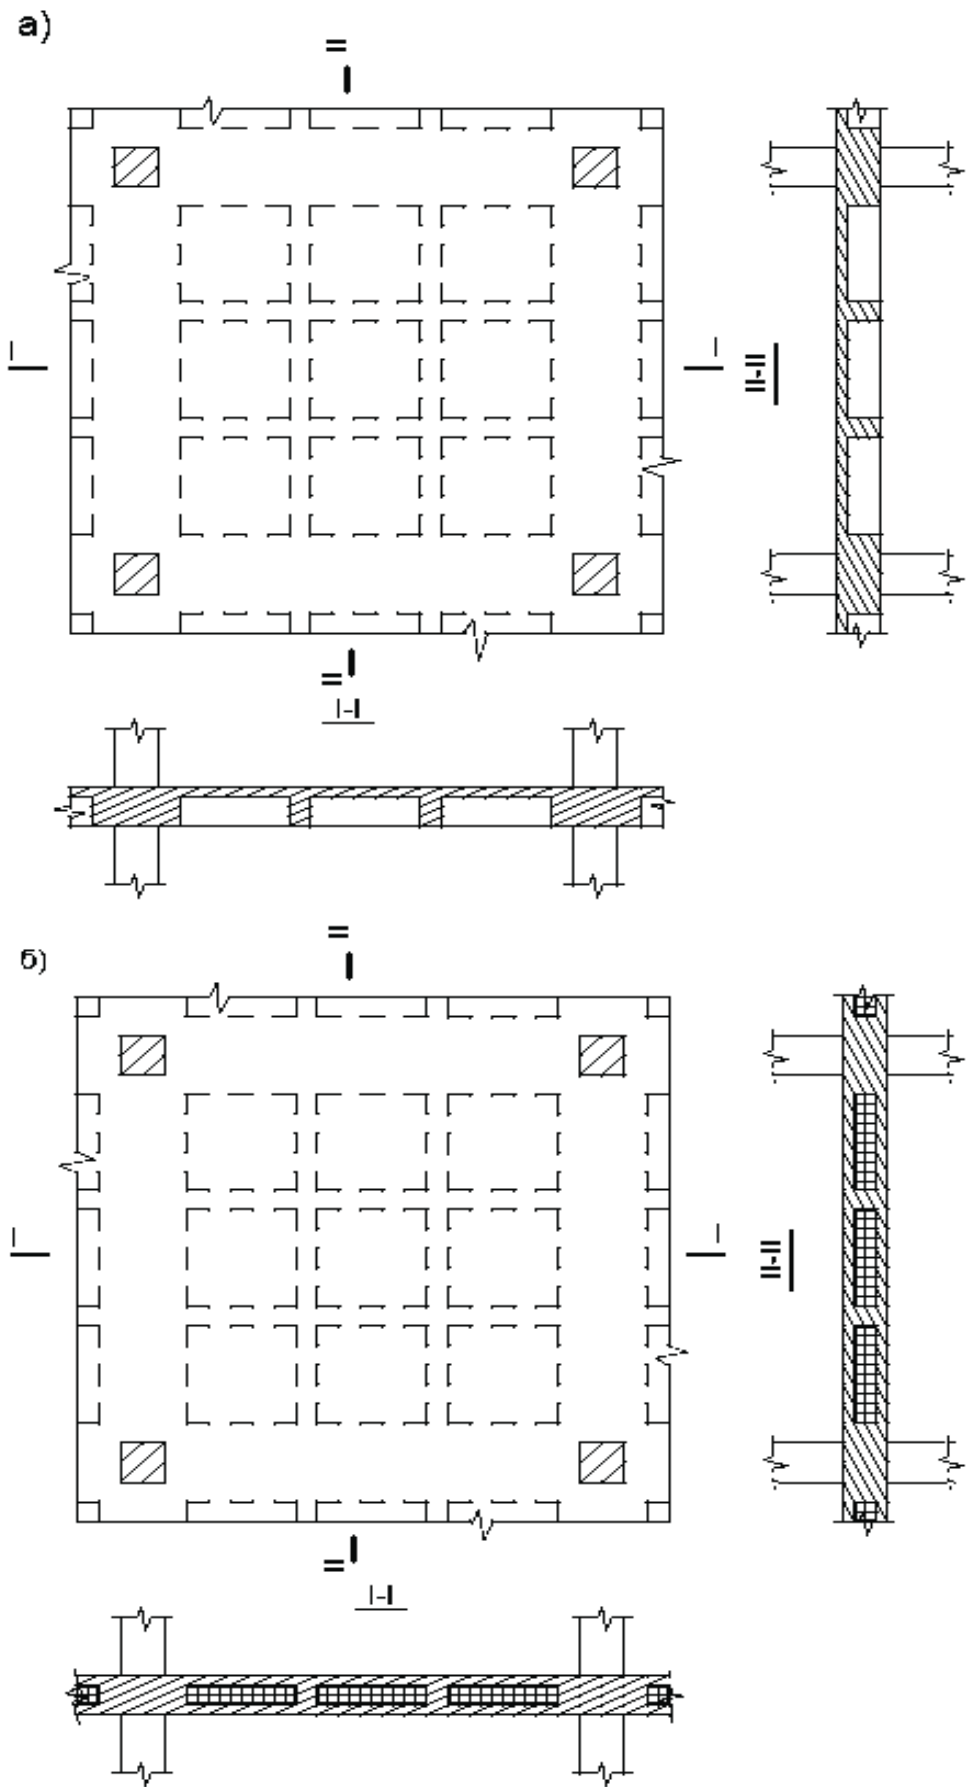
Схемы кессонного (а) и пустотного (б) перекрытий.
